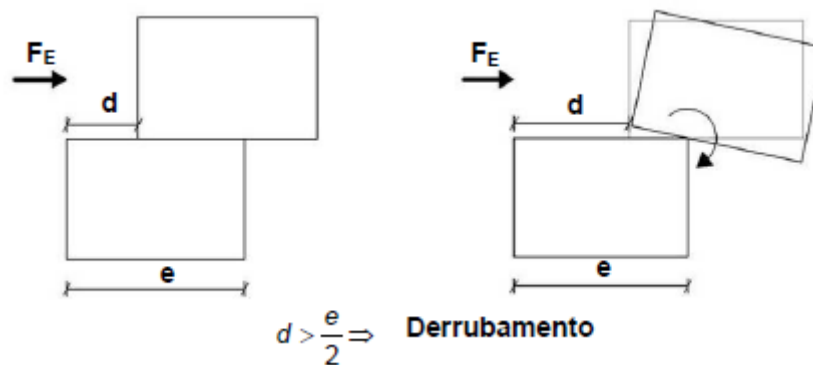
Mecanismo de deslizamento e consequente derrubamento no plano da parede [26].
